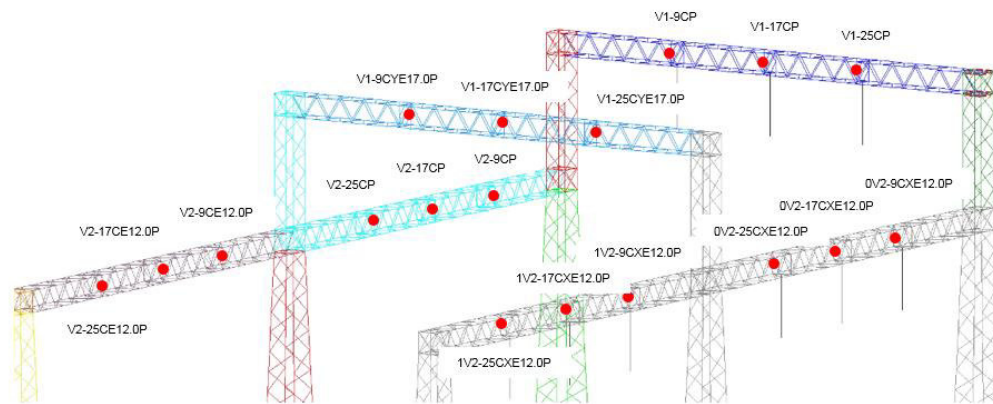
Etiquetas de nudos para cargas de conexionado
